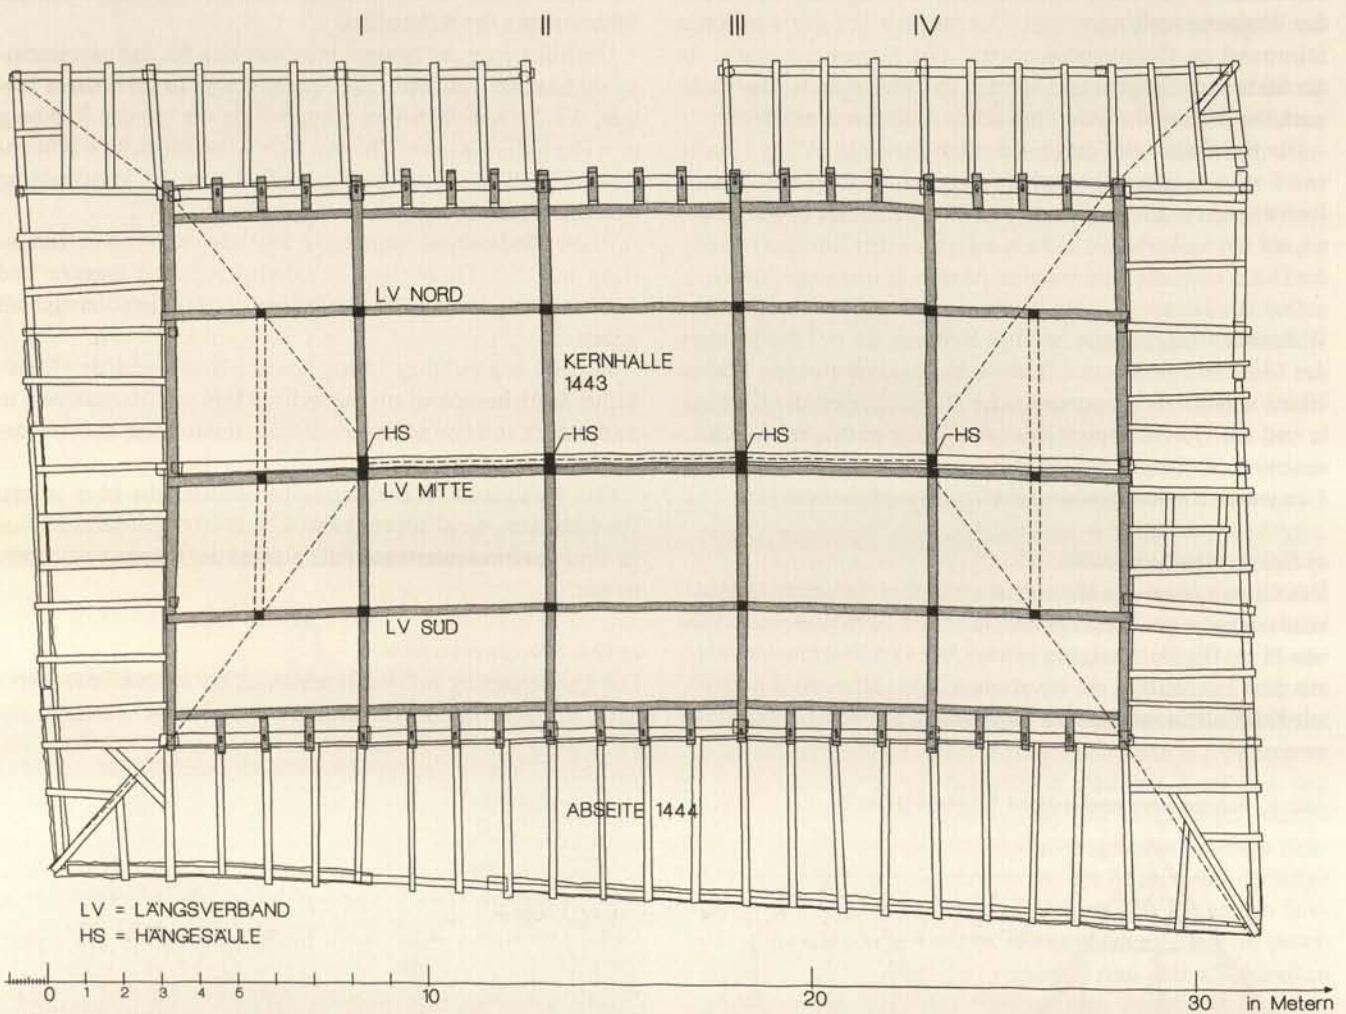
Grundriß mit Balkenlagen über der Kernhalle und den Abseiten.
